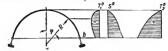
Виутренние усилия в шаровой оболочке от ветровой нагрузки.
